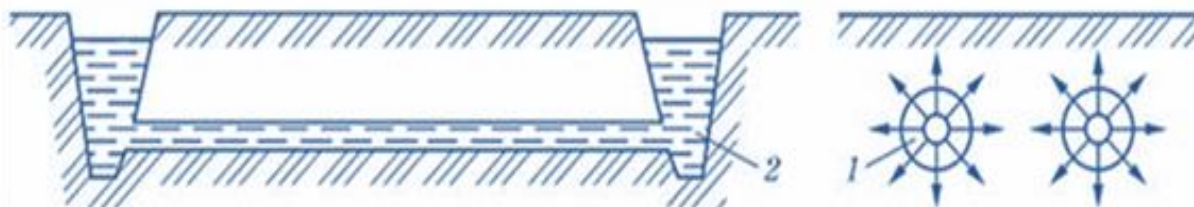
Схема підґрунтового зрошення: 1 – дренажні труби; 2 – кротовини
